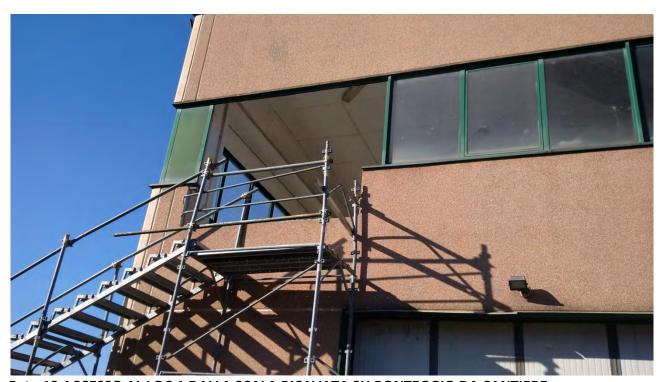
ACCESSO AL LOC.1 DALLA SCALA RICAVATA SU PONTEGGIO DA CANTIERE
